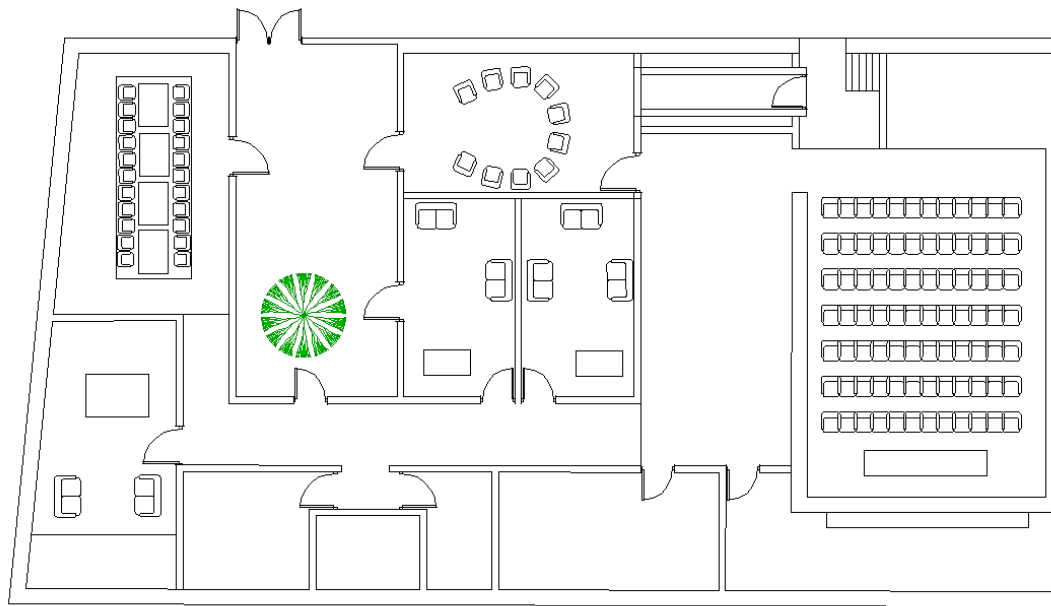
Planta Arquitectónica, Centro Parroquial Ballyroan. Fuente: Centro Parroquial Ballyroan / Box Architecture
